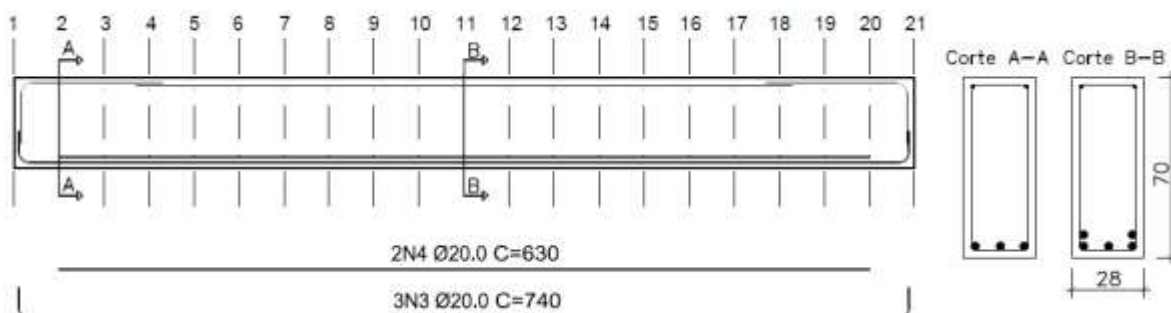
Detalhamento da Viga 2. Fonte: Elaborado pelos autores.
